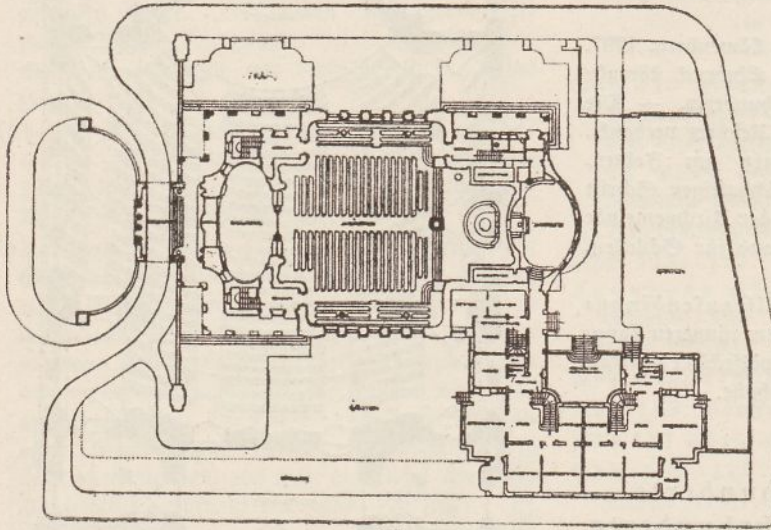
Görlitz, Kreuzkirche, Grundriß.
